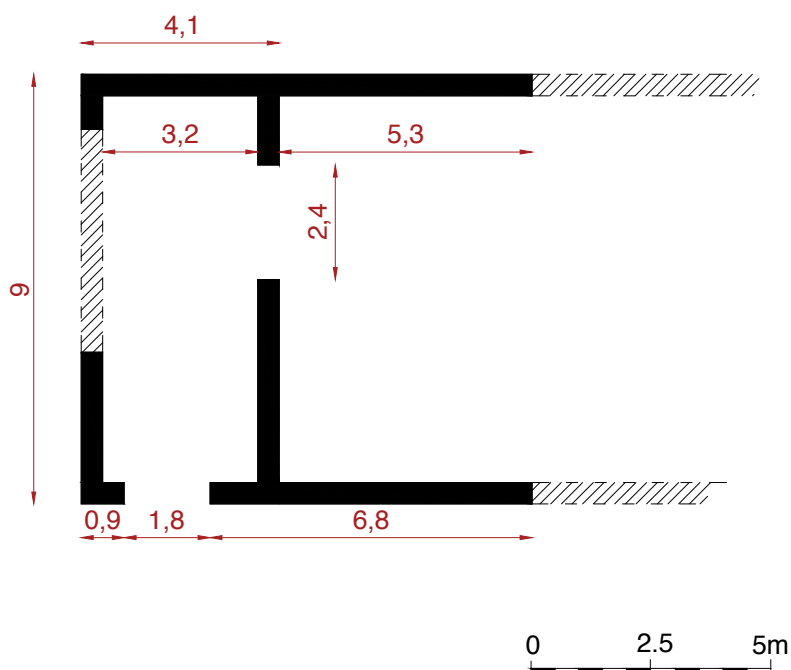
Pianta della nuova struttura, indicata con la lettera E nella planimetria generale del sito di Persqop (Fig. 83)
